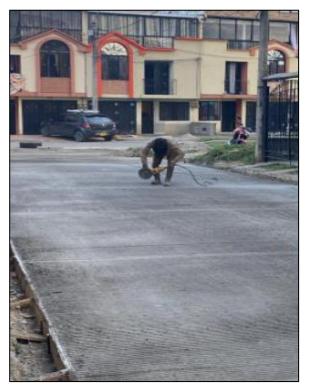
Fuente propia: Realización de cortes en el pavimento
